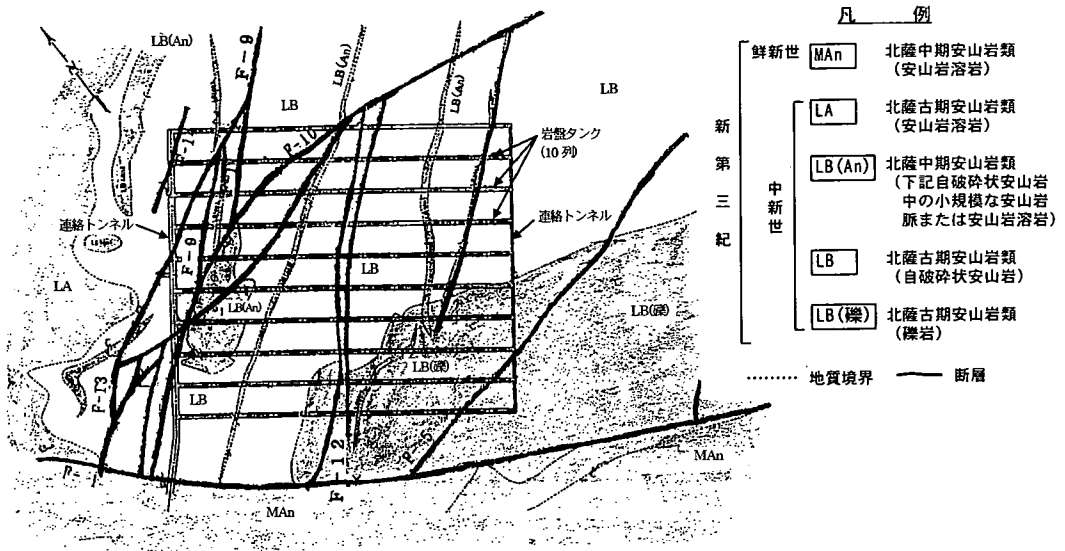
串木野基地地質平面図 (EL-27.5m レベル) ⑥
